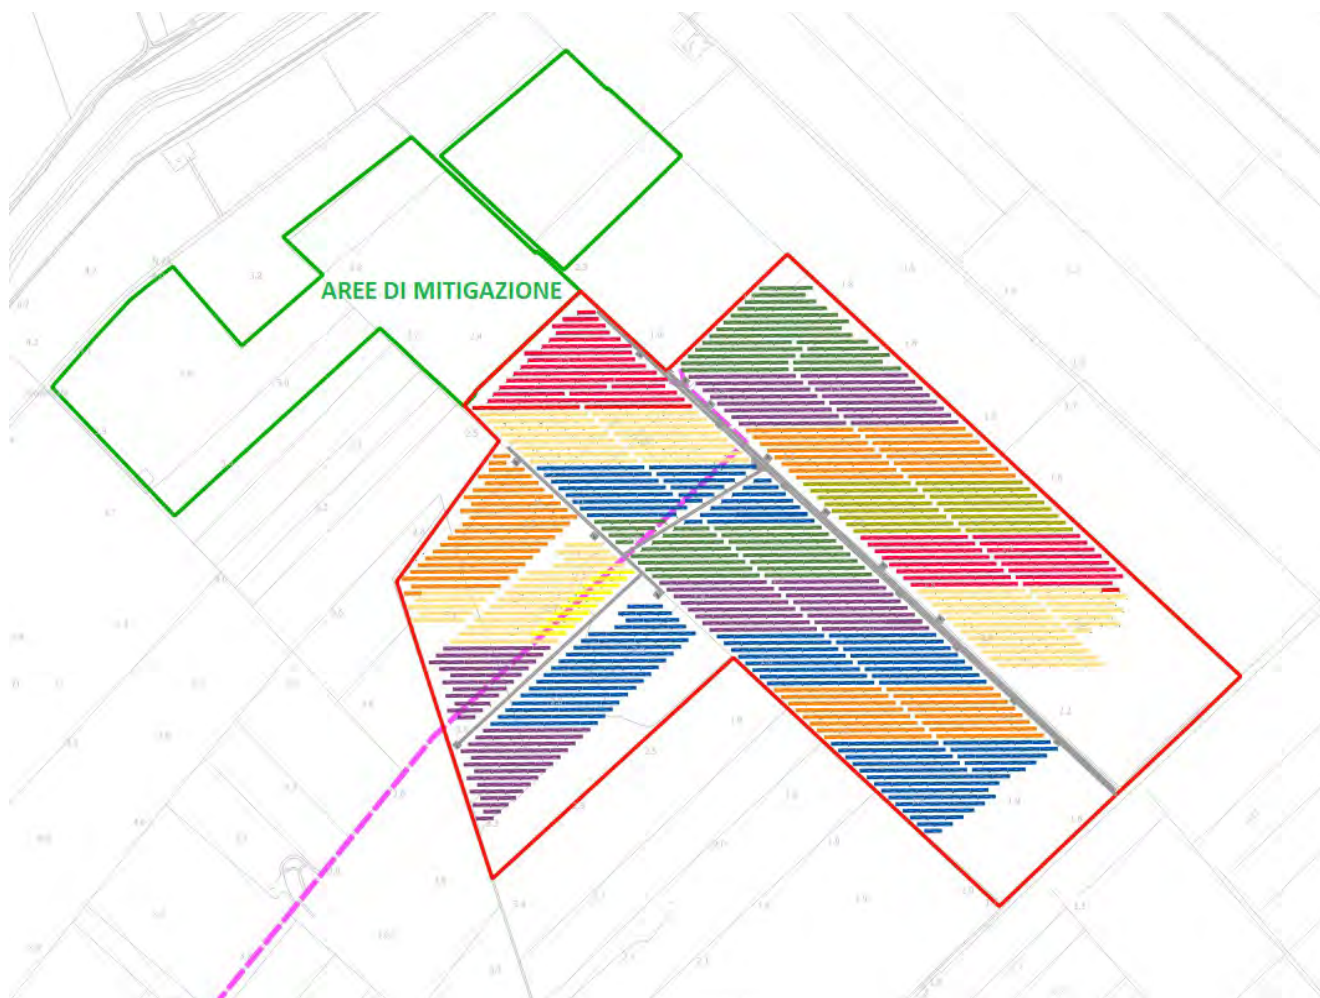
Planimetria generale con individuazione delle aree di compensazione ambientale
